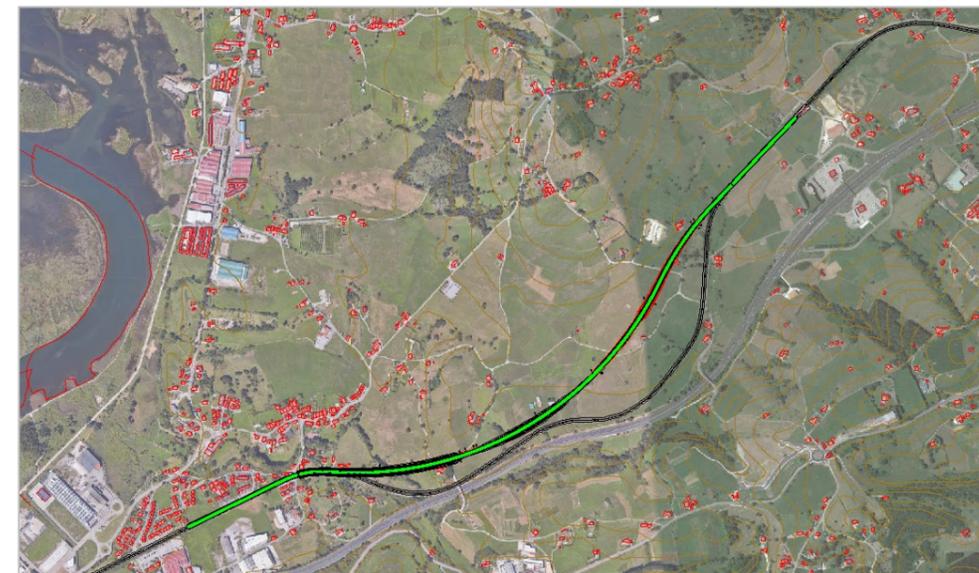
Trazado en planta entre Mar y Gornazo. Fuente: Autor
